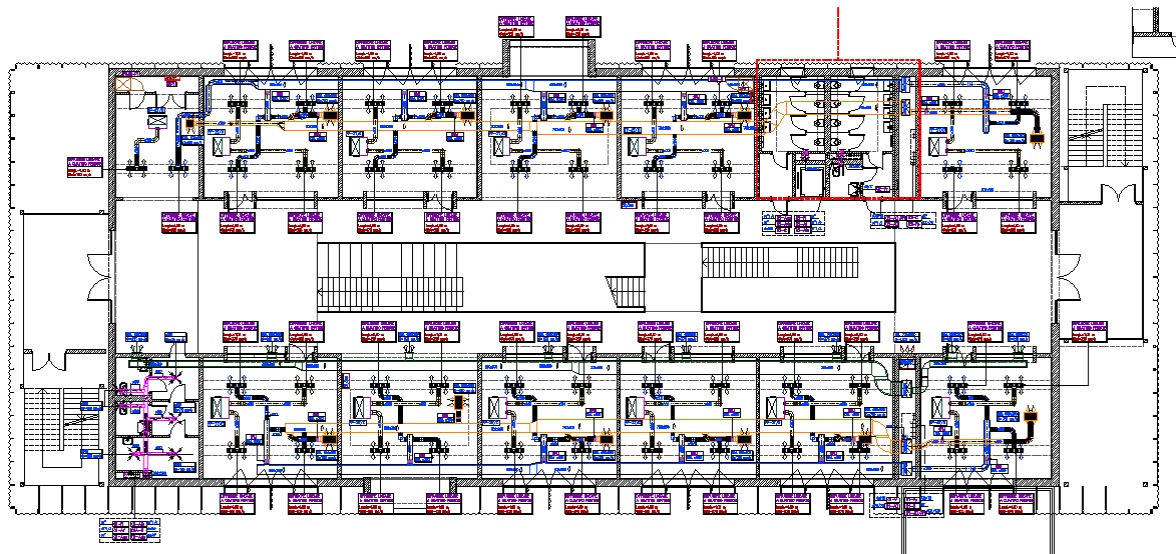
Pianta copertura palestra: impianto termico in progetto
